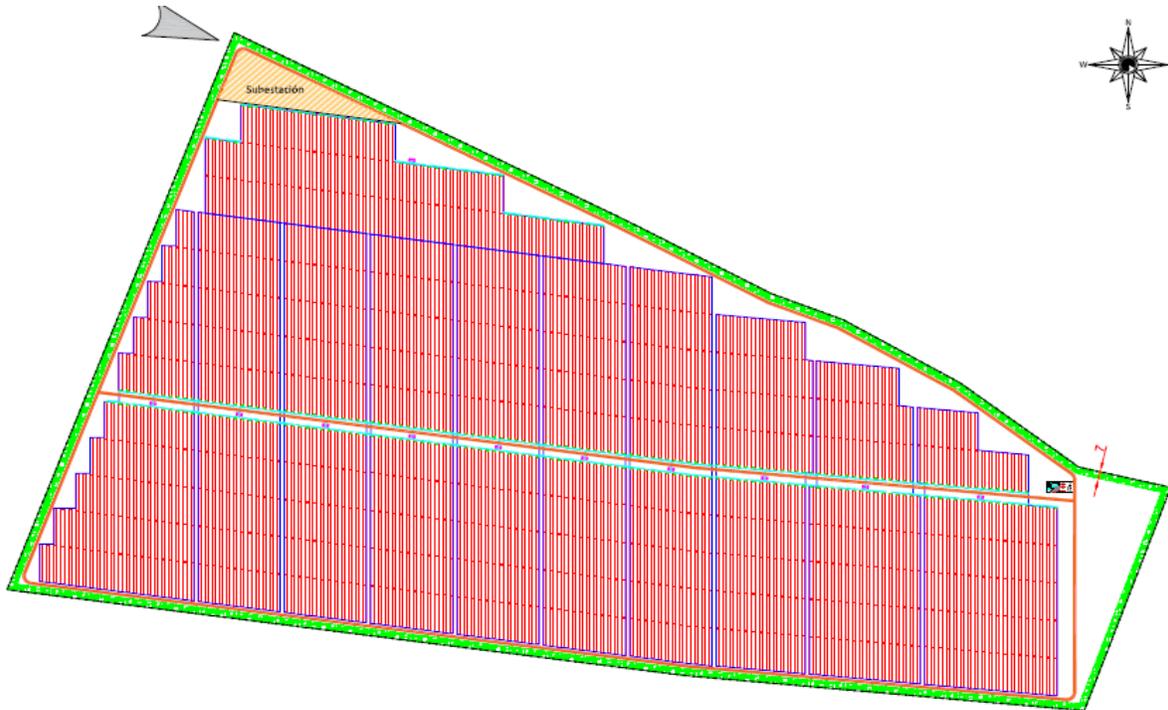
Plano del proyecto (Planta fotovoltaica)
